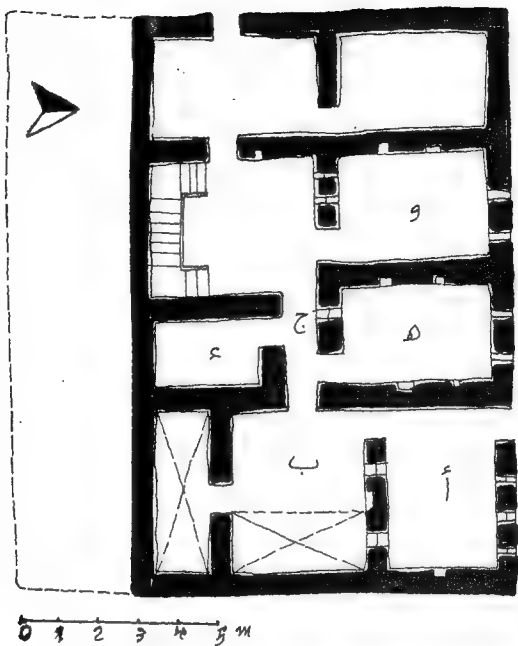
منزل ابو همام الدور الأول - مسقط أفقي
